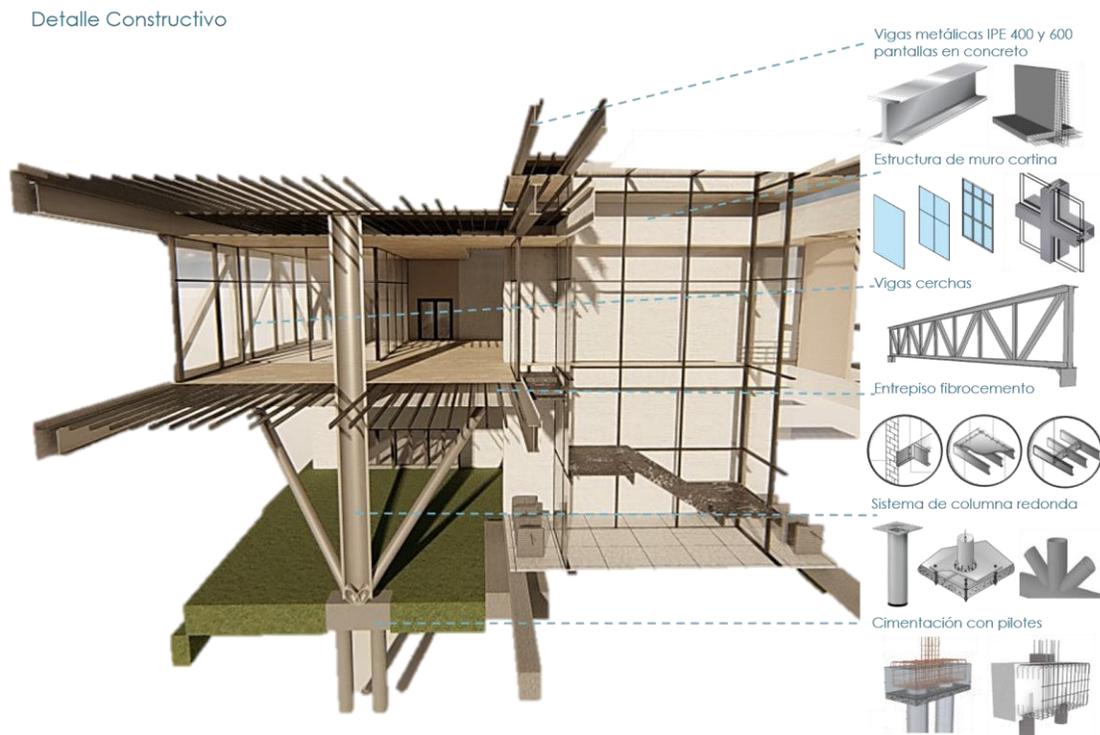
Corte que muestra las distintas partes estructurales del proyecto.
